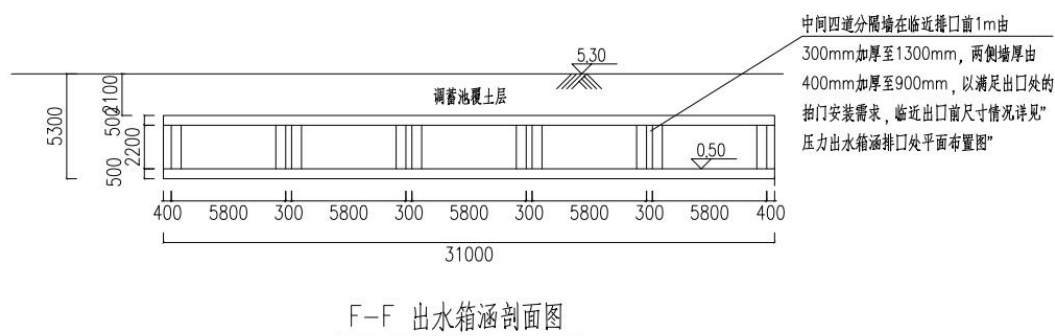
调蓄池压力雨水出水箱涵剖面图 (F-F)
